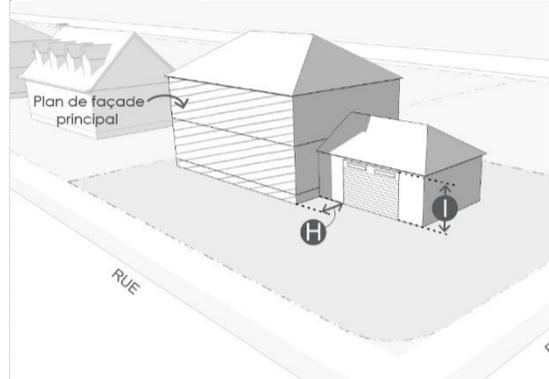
Retrait d'un garage par rapport à un plan de façade principal et hauteur d'une porte de garage
